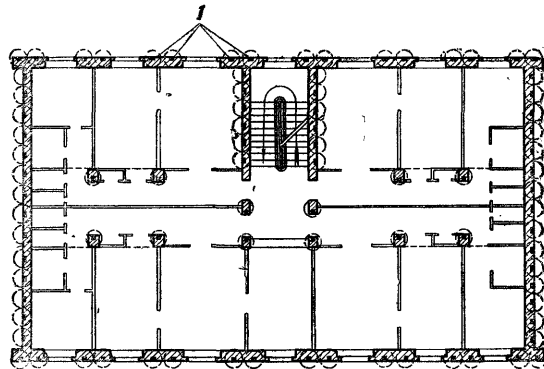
Обрушение секции здания на месте подрыванием всех капитальных стен и колонн:
